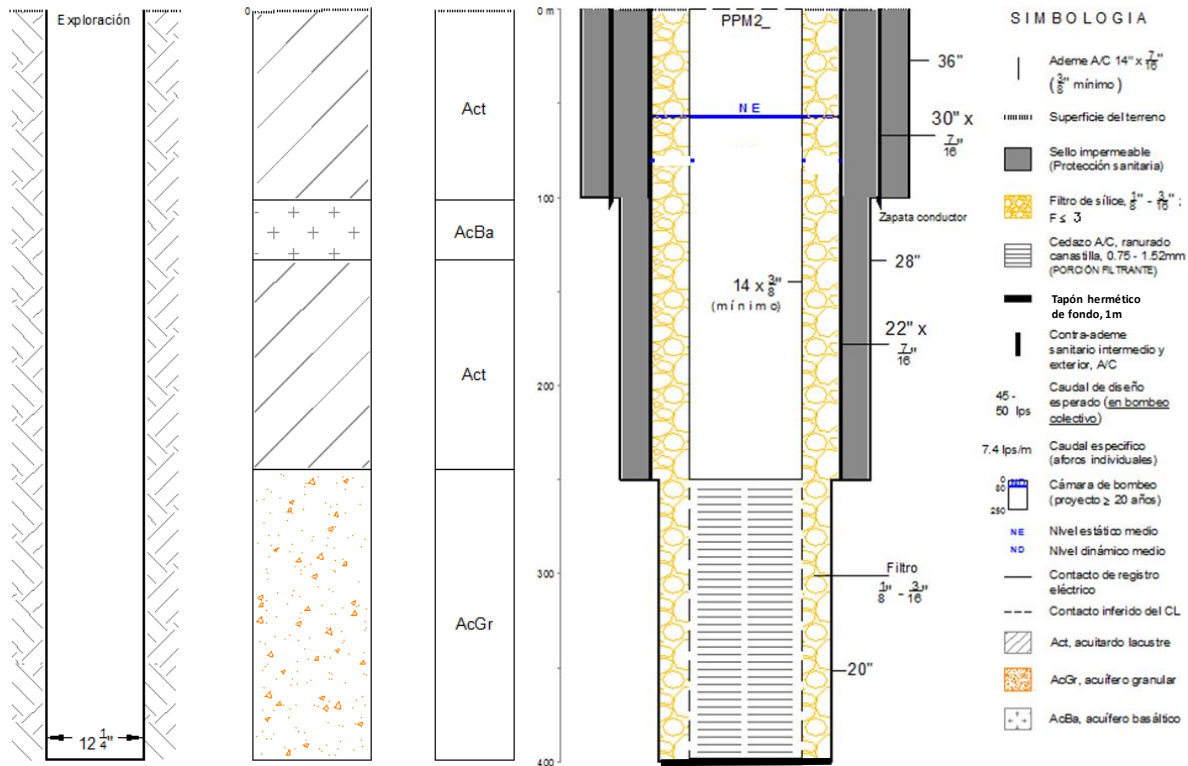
Proyecto de Pozos Mixquic 2
